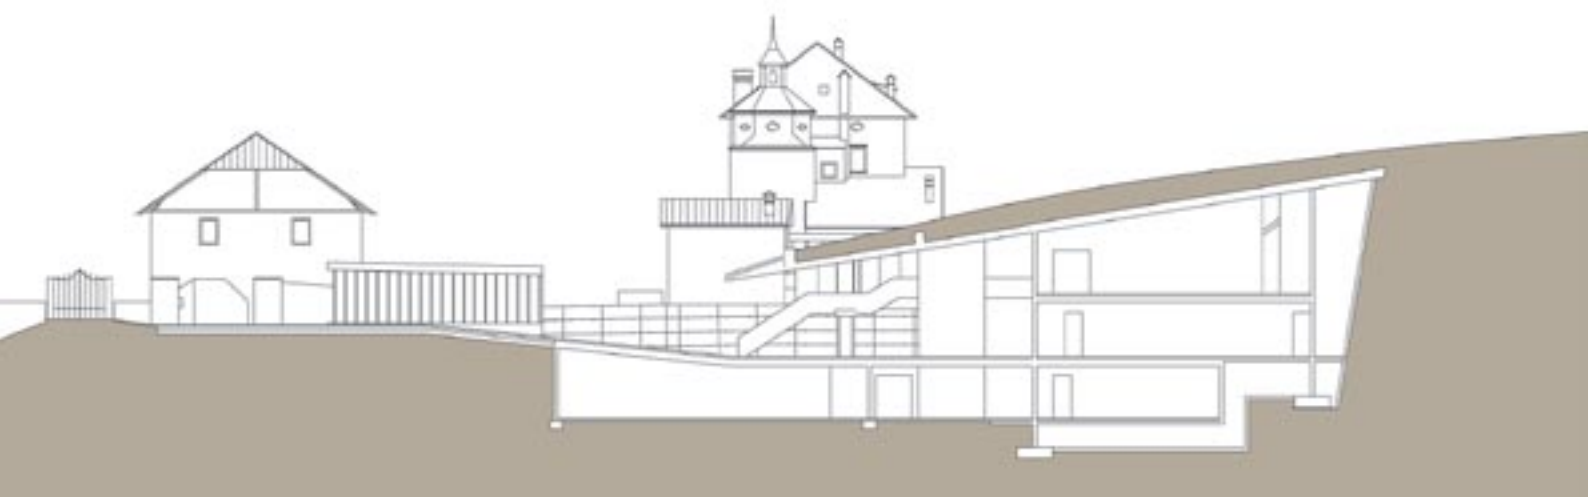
e I.62: Prospetto e sezione verticale dell'ampliamento
